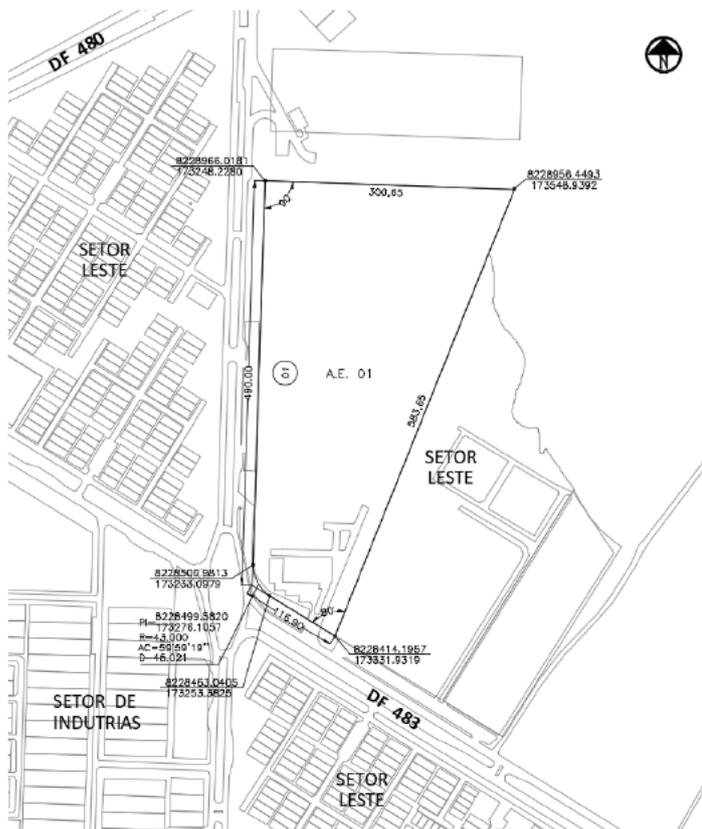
Planta de situação do Lote 01 - AE Indústria - Setor Leste - Gama (DF)
